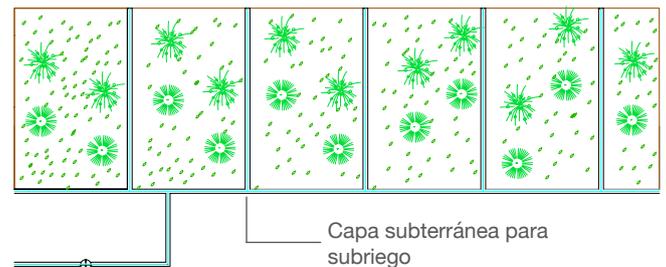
Vista en planta de la capa subterránea para el riego de tierra
